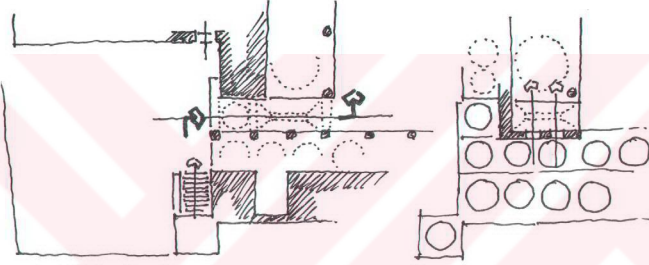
Vaziyet planı (ŞİMŞEK 1987, şek. 29'dan; çizim: A.S. ÜLGEN)
